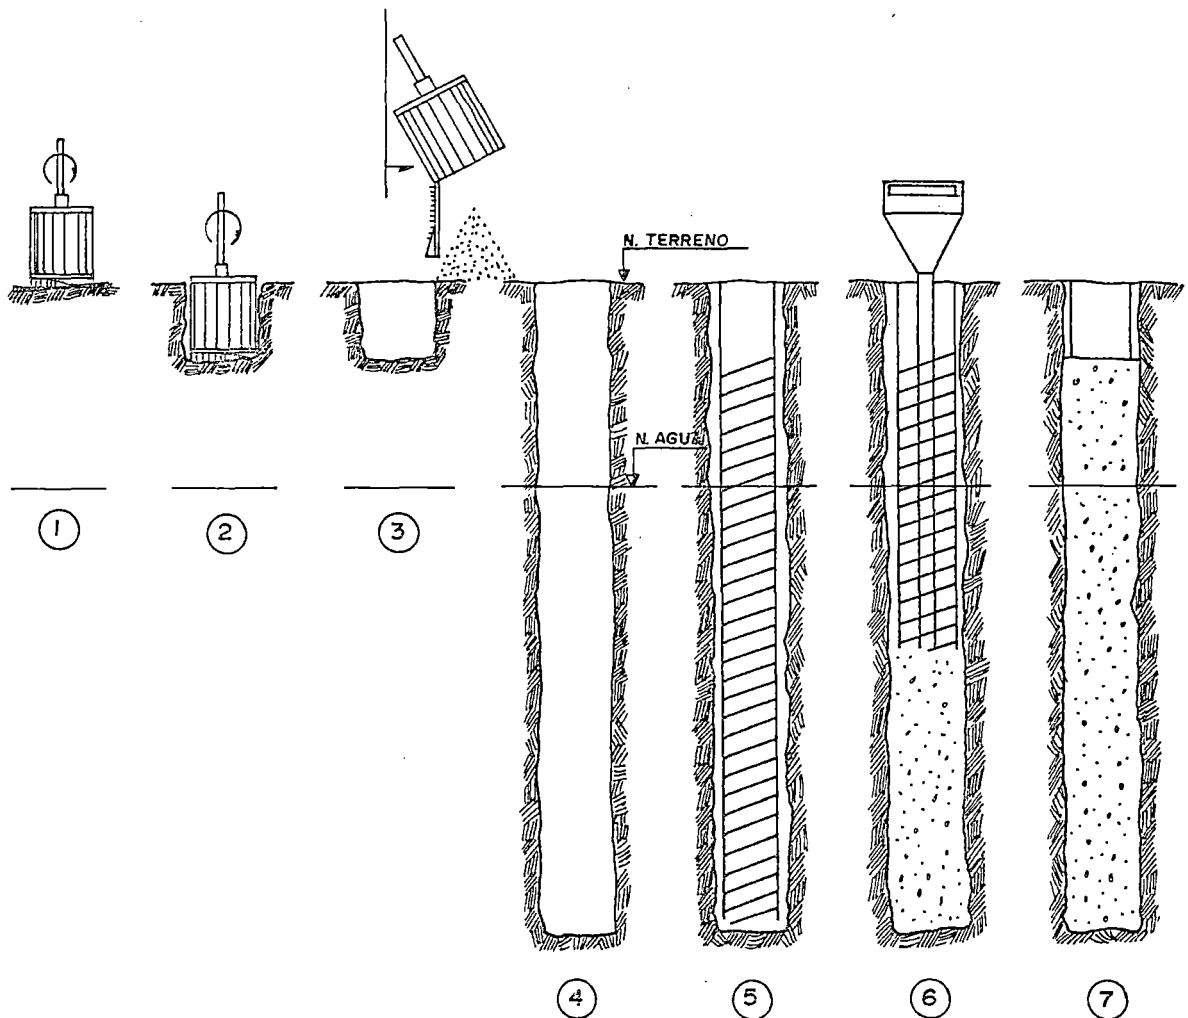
Proceso constructivo de pilotes excavados VSL.
